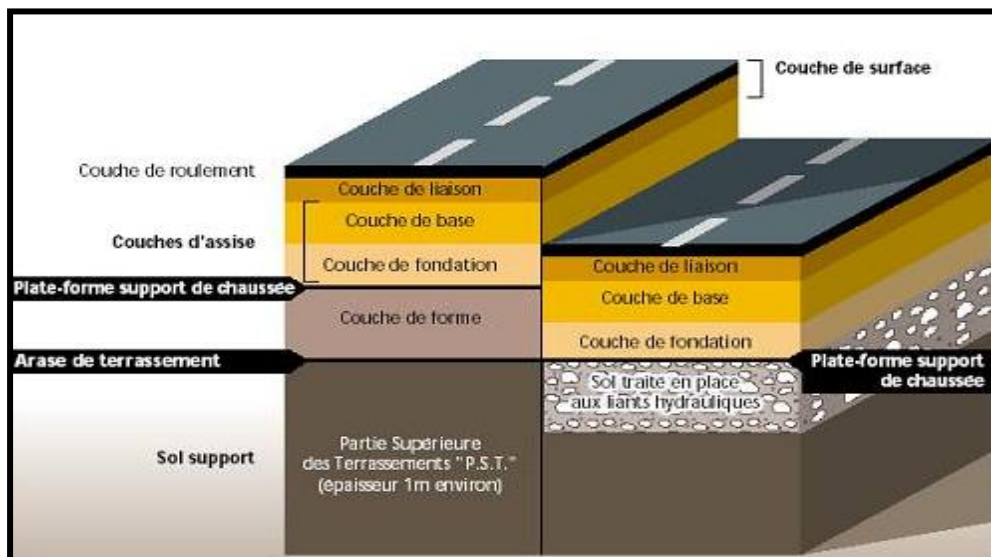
les différentes couches qui constituent la structure de la chaussée
